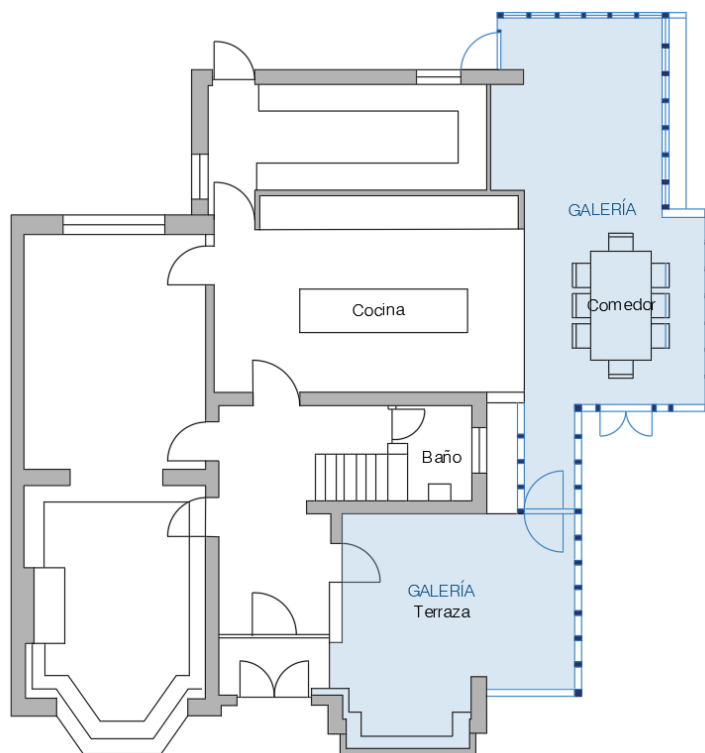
Planta primer nivel de Glass Ribbon. Fuente: Elaboración propia en base a Scullion Architects
